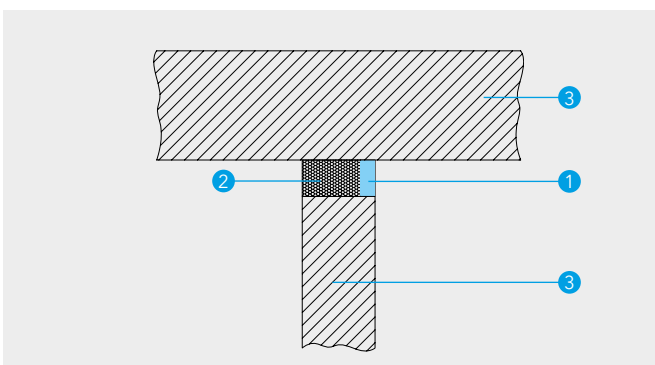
Detail D - Enkelzijdige voegafdichting in massieve wand - op onbrandbare rugvulling
